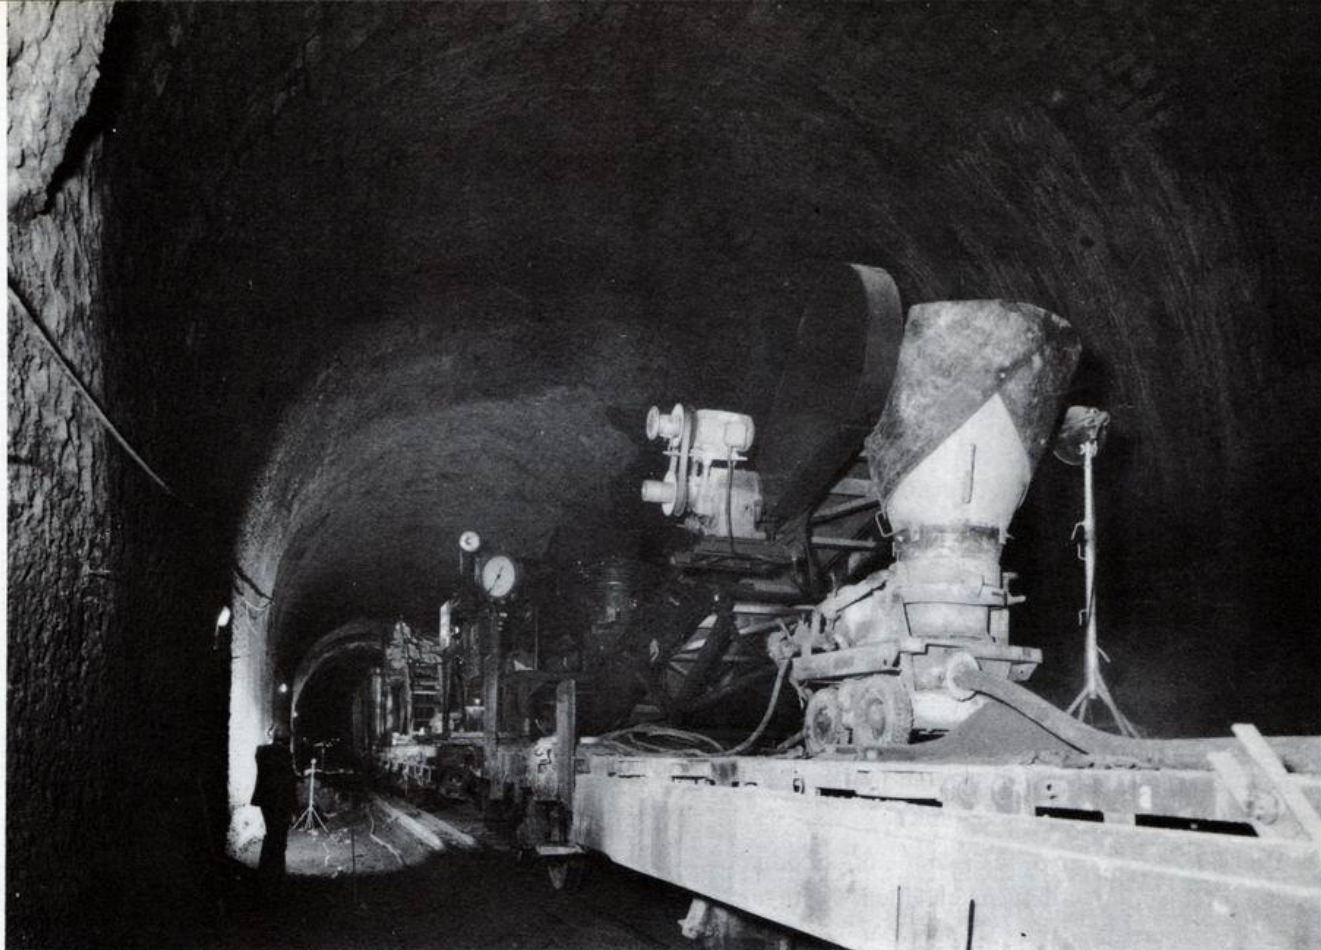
Tunnel de Belleville : centrale de projection du béton.
